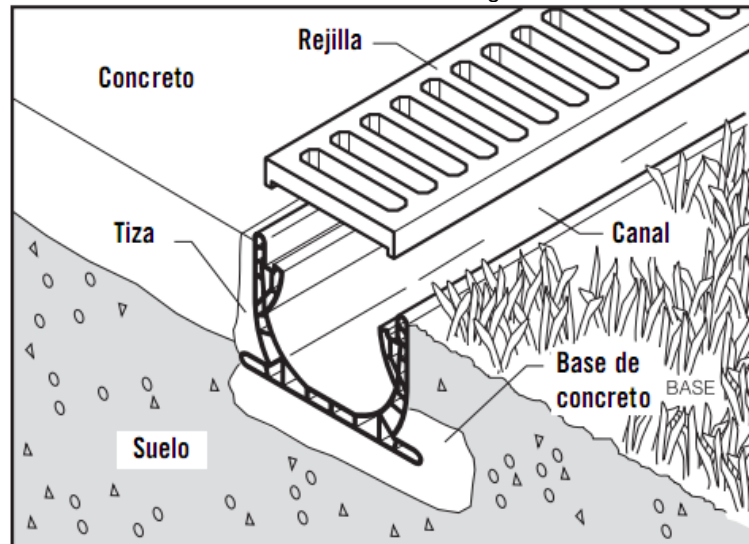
Drenaje adecuado para la instalación de las Nutrias
